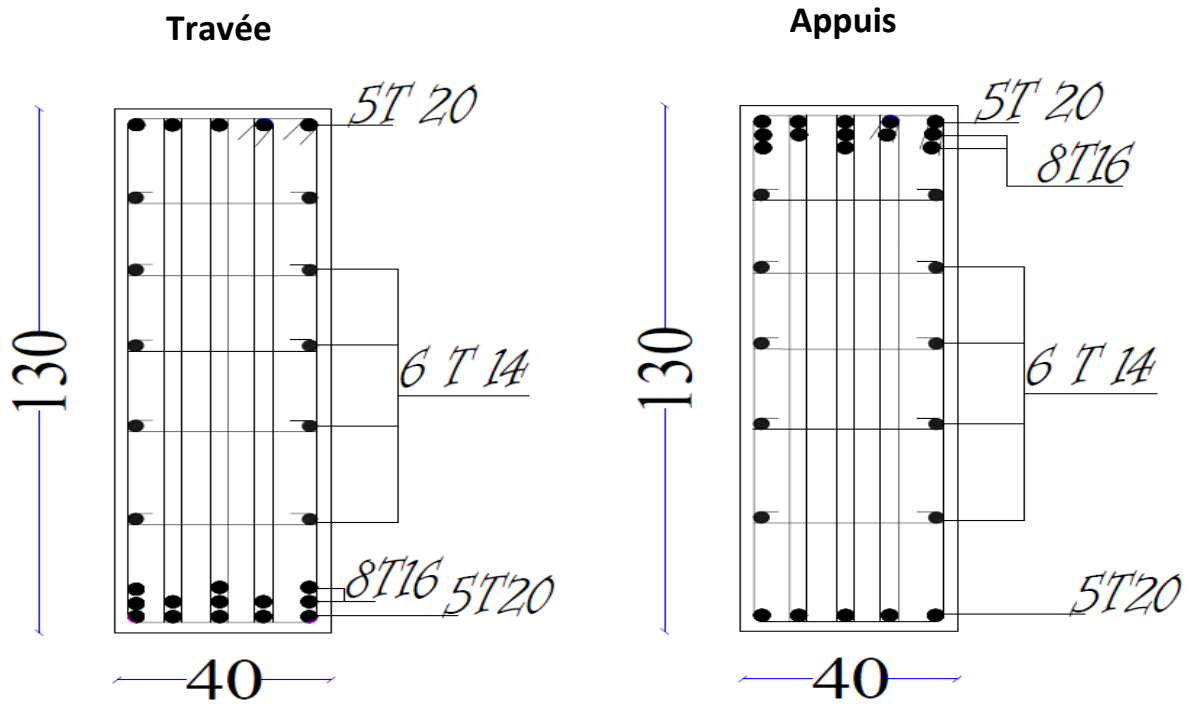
Ferrailage de la poutre secondaire (130×40) cm²
